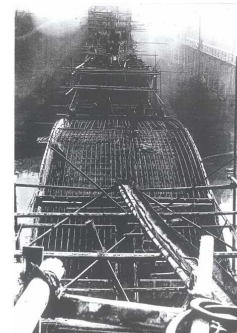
当初施工時の写真の一例(アーチリブの配筋状況) (株)斎藤組(埼玉県秩父市) 提供
